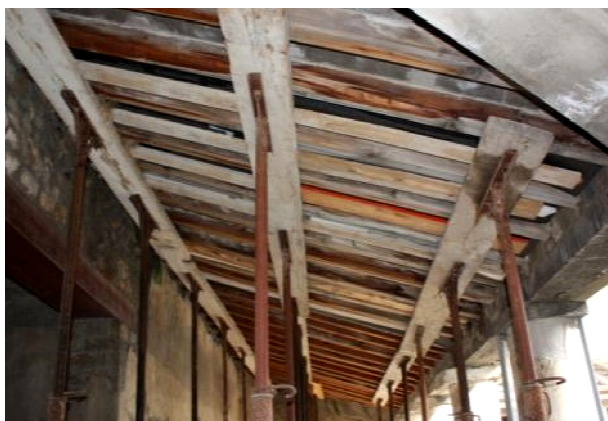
Portico ovest, cedimento dei travetti del colonnato.
